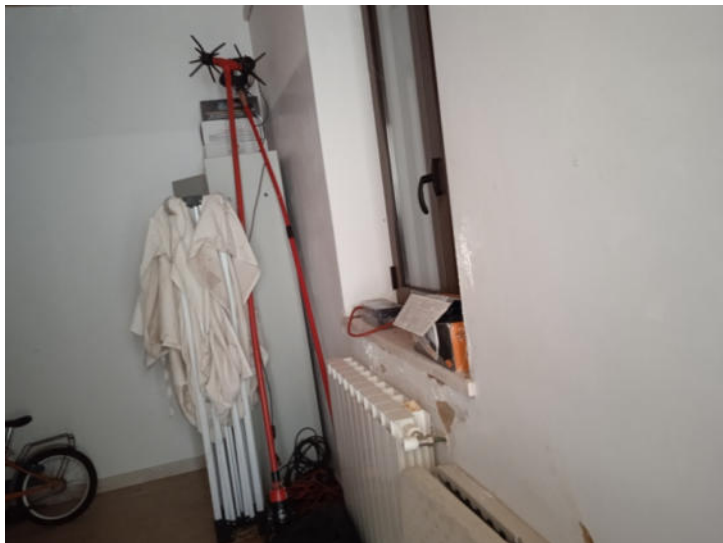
Fabbricato B - Piano primo - Vista interna - Part. 476 sub2
